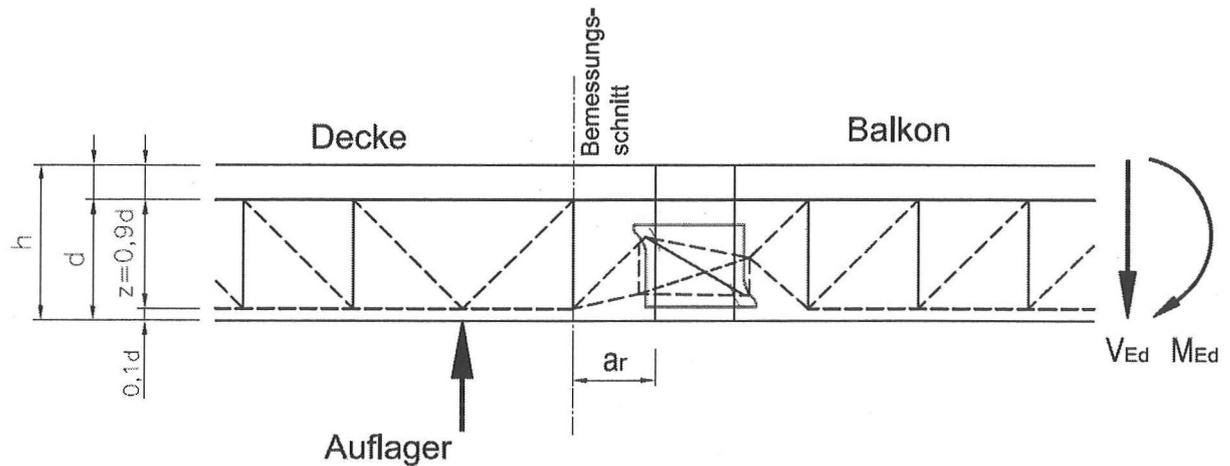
Fachwerkmodell und Bemessungsschnitt HIT-HP/SP MV mit Druckschublager
